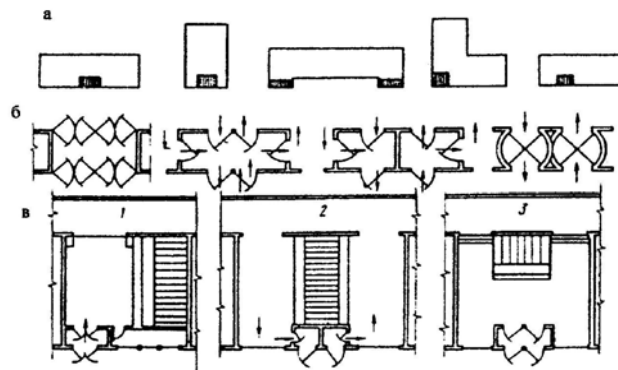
Планувальні схеми вхідних вузлів громадських будівель:
